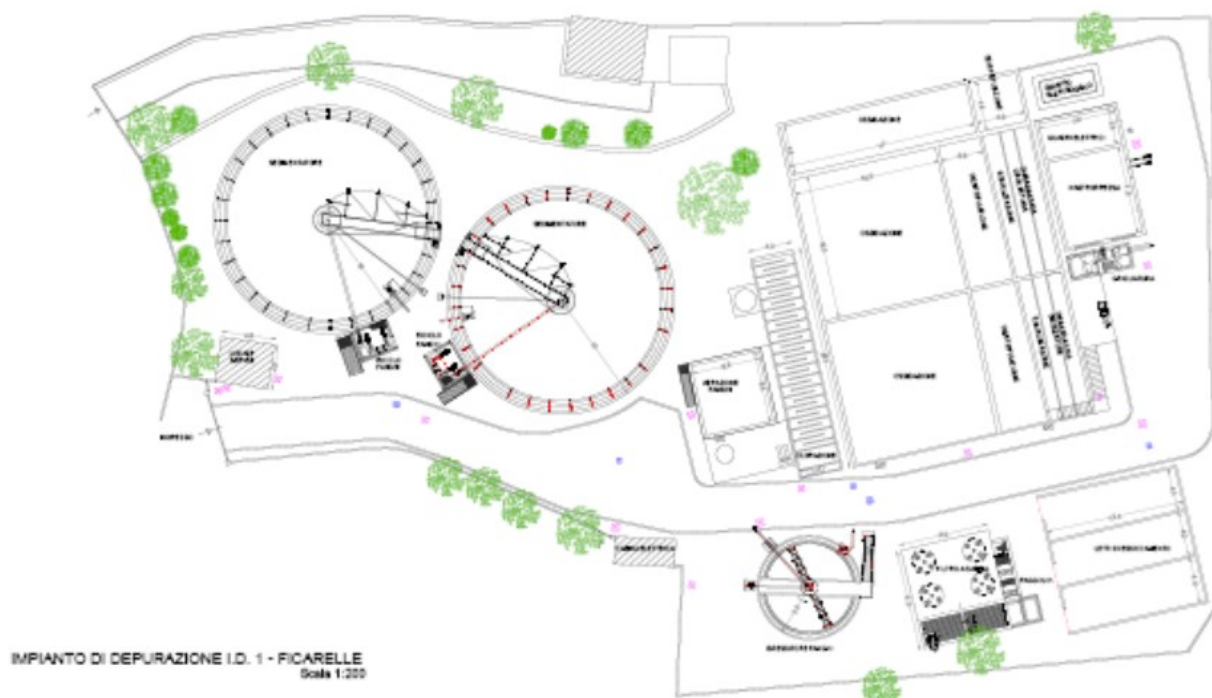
Planimetria dell'impianto di depurazione (stato di fatto)
